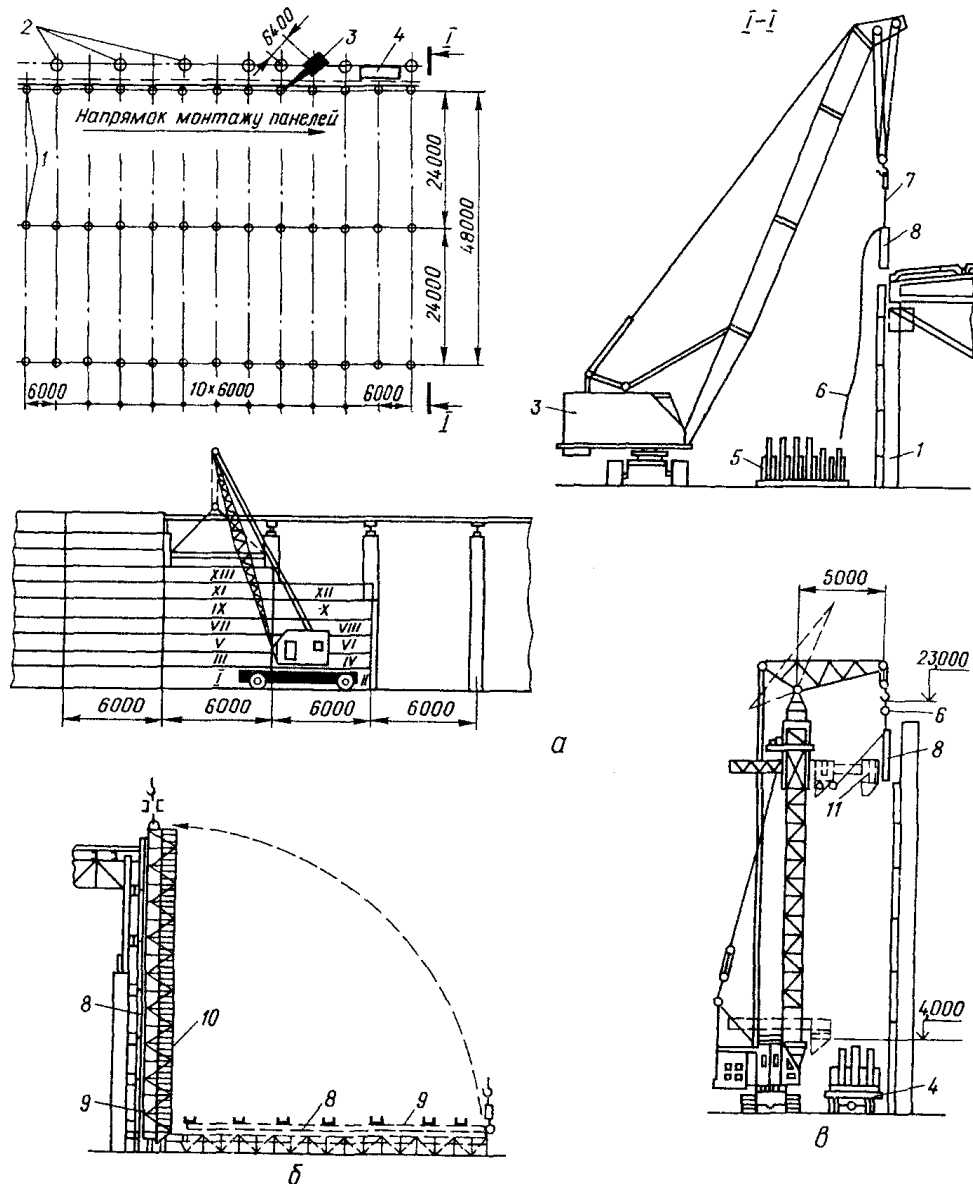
Монтаж стінових панелей: *а* - схема монтажу; *б* - складання та монтаж стінової огорожі великими блоками; *в* - обладнання крана пересувними риштуваннями для монтажу панелей; 1- колона; 2- стоянки крана;3- кран; 4 - панелевоз; 5 — касета для складування стінових панелей; 6 — відтяжка; 7 - двовітковий строп; 8 - стінова панель; 9 - стояк; 10- драбина; 11- висувні підйомні риштування; I-III- послідовність монтажу
